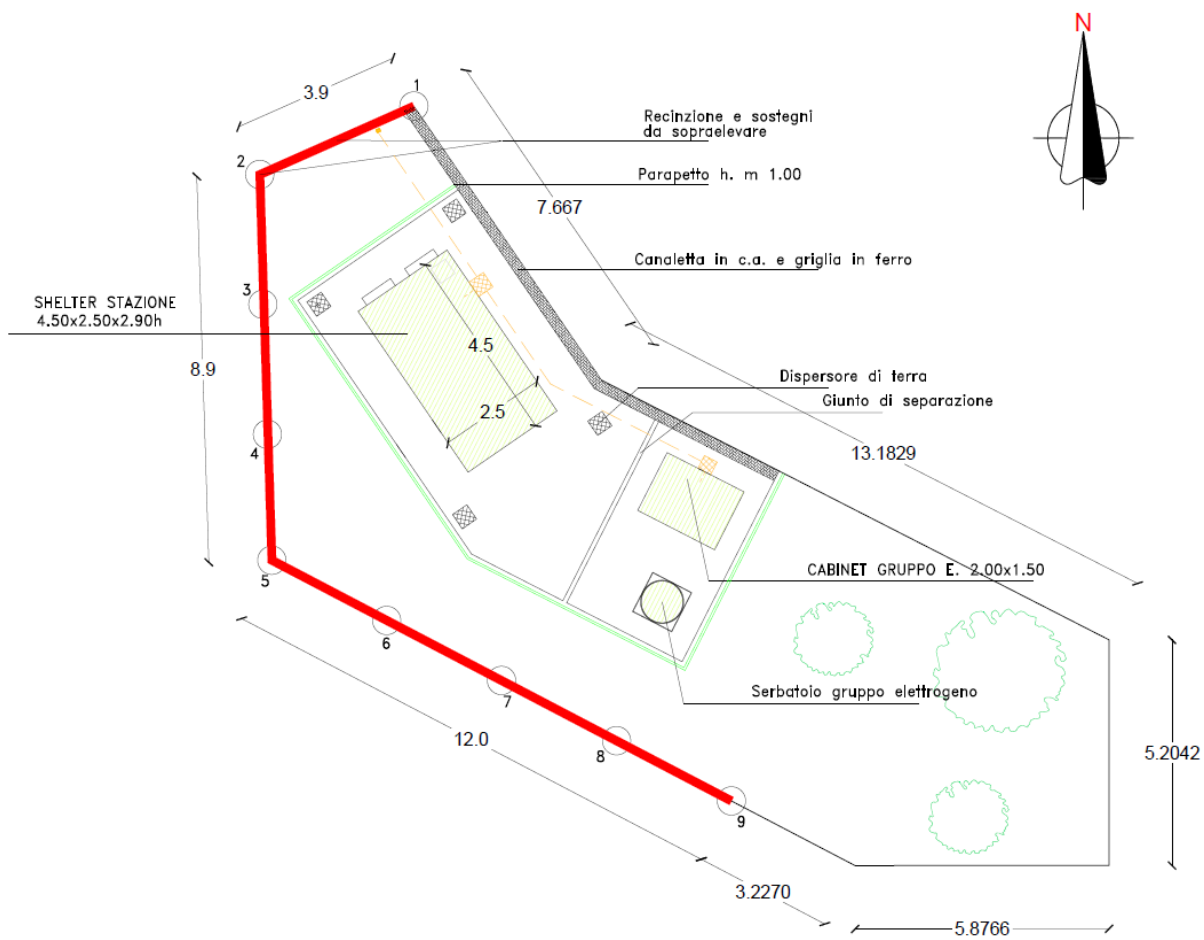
Planimetria del sito in cui è installata la stazione Remrad di Monte S. Angelo
